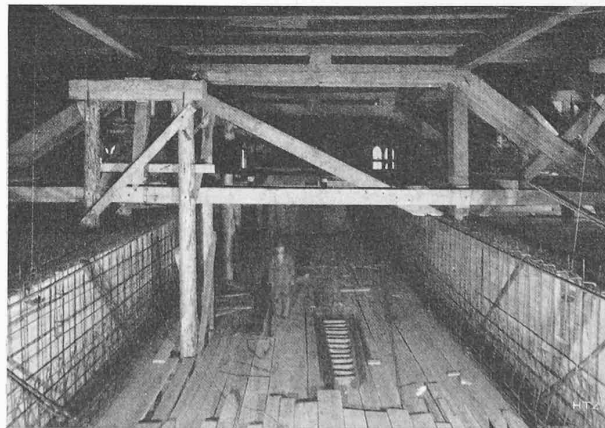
Einbau der 2,30 m hohen Eisenbetonträger (vgl. Abb. 3)
